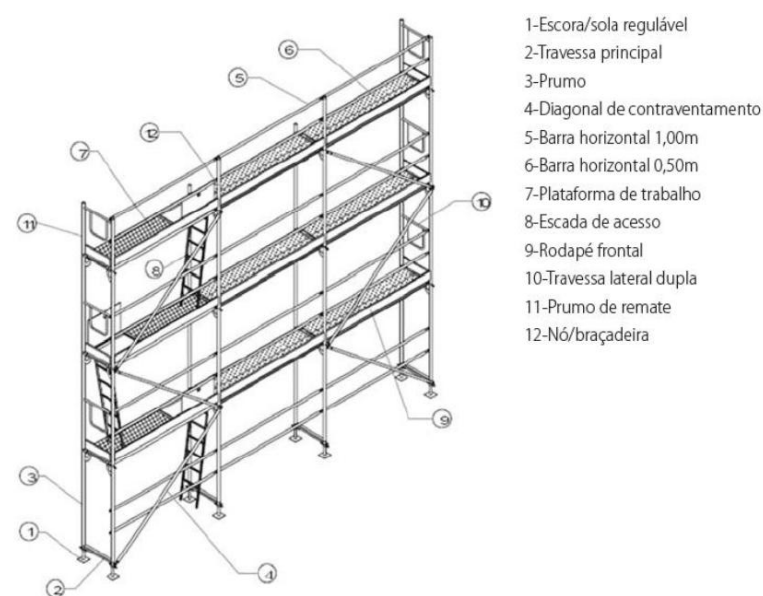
Elementos constituintes de andaime metálico de pés [19]
